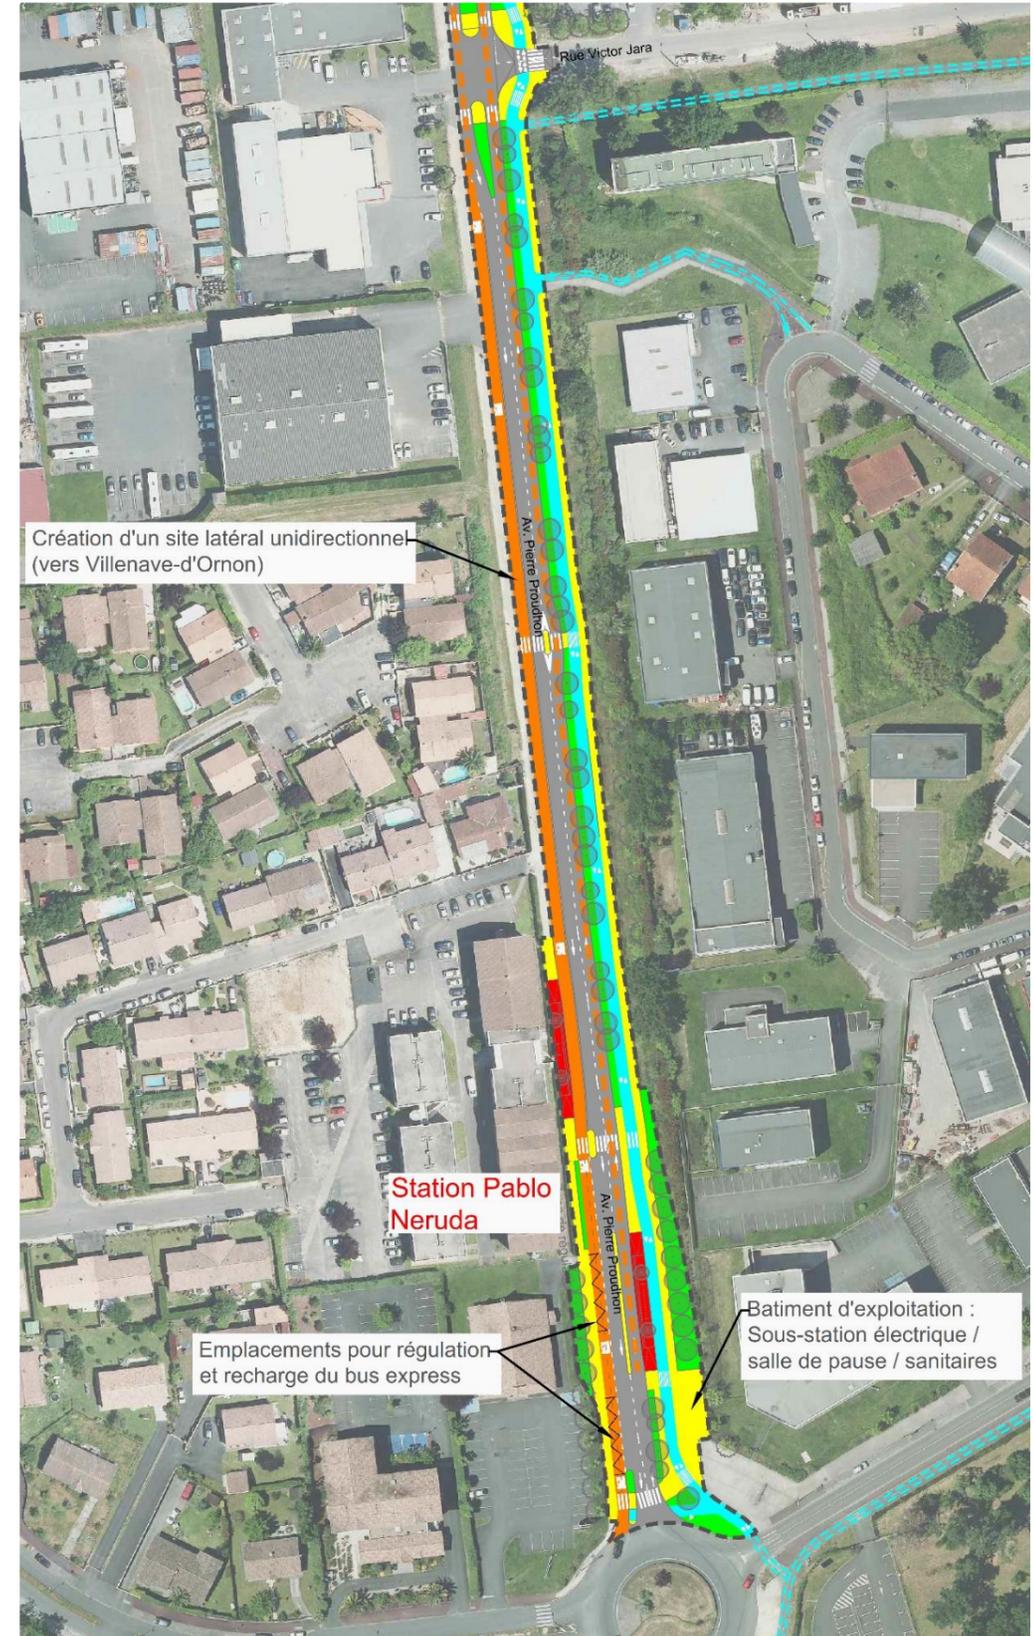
Extraits de plan sur l'insertion sur l'avenue Pierre Proudhon
